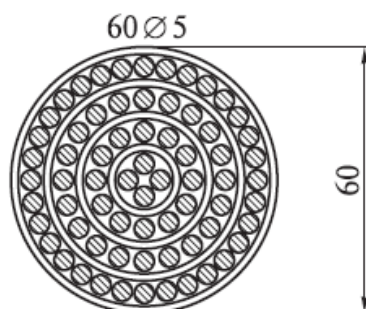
Конструкция пучка напрягаемой арматуры
